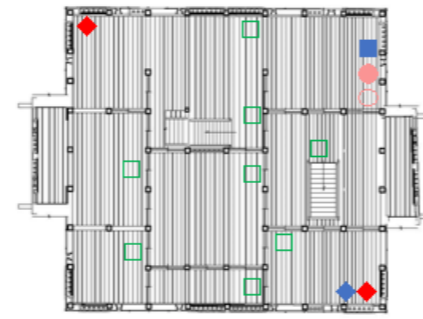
天守 1 階平面図及び東廊下・南廊下 2 階平面図（復元原案）
